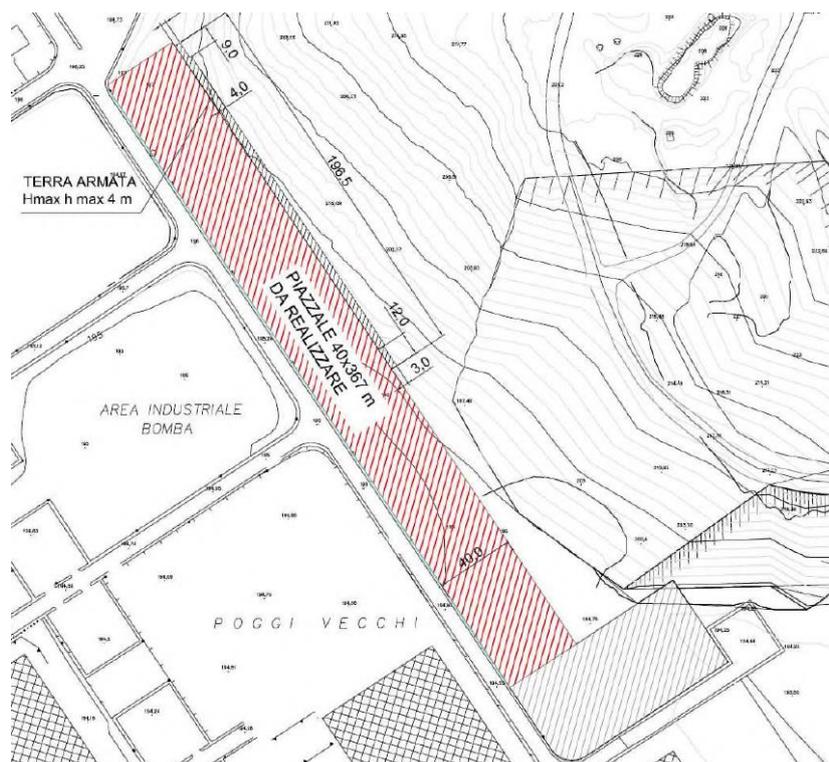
MA11Ind –Poggi Vecchi Industriale: Planimetria del nuovo piazzale e del muro in terra armata.
